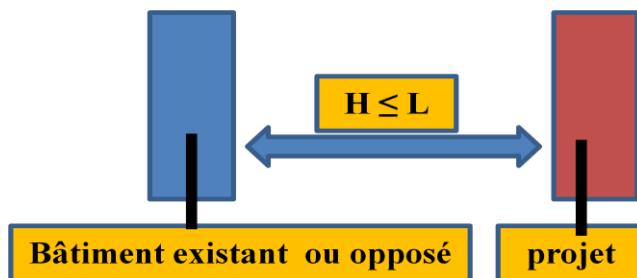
La hauteur du projet par rapport au bâtiment existant ou opposé
